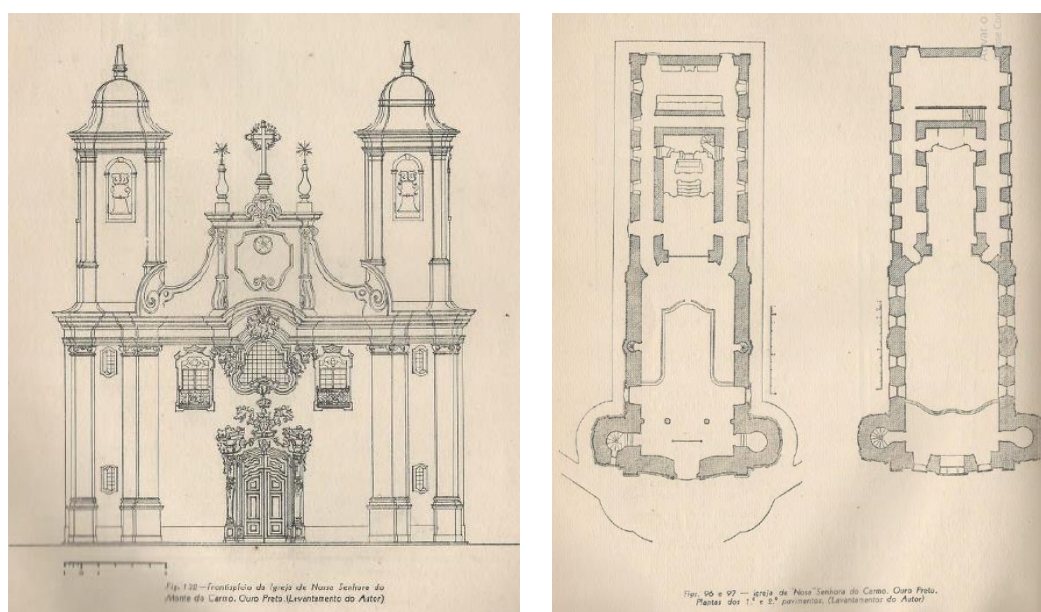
Frontispício e Planta baixa do 1º e 2º pavimento da Igreja da Ord. 3º de N. Sra, do Carmo. Levantamento realizado por Paulo F. Santos. (SANTOS, 1951, p. 175 e 148 respectivamente).
